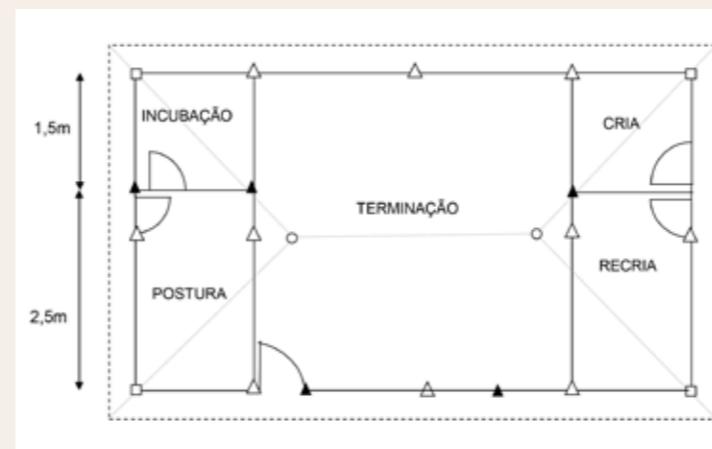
Planta baixa de aviário para aves caipiras de corte.
